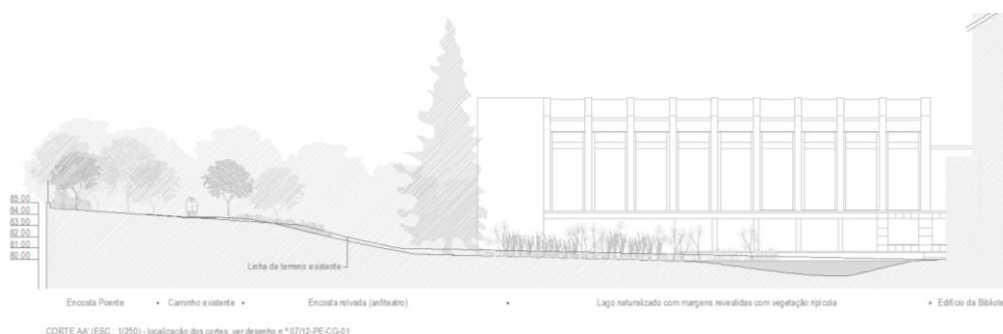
Corte do Projeto de Arranjos Exteriores da BNP – Arq.º João Ceregeiro (Maio de 2019).
